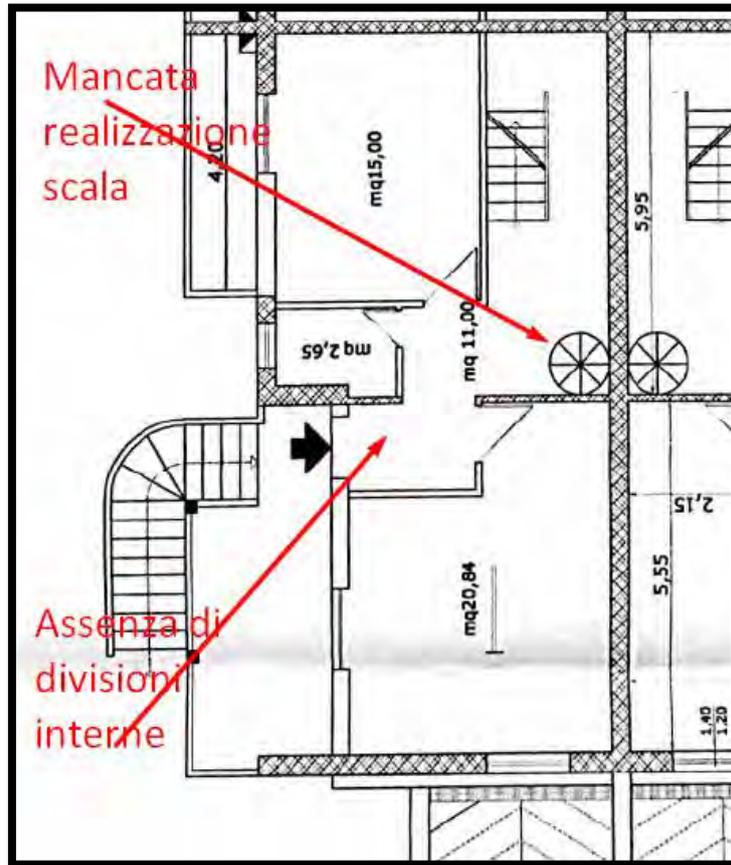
Pianta piano primo allegata alla CILA prat. n. 294/2011
